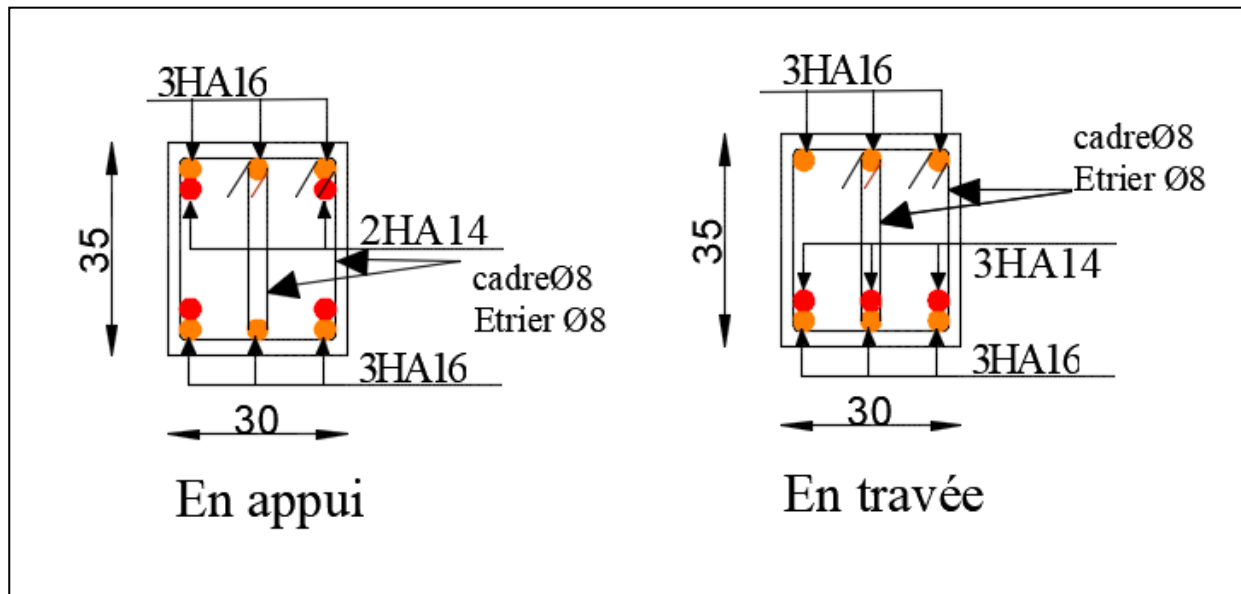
Schéma de ferrailage des poutres principales de l'étage.
